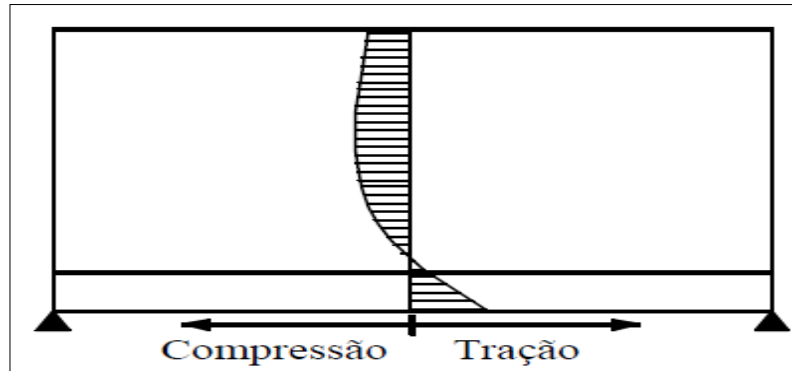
Distribuição de tensões na parede e na viga. (Fonte: Barbosa, 2000)
